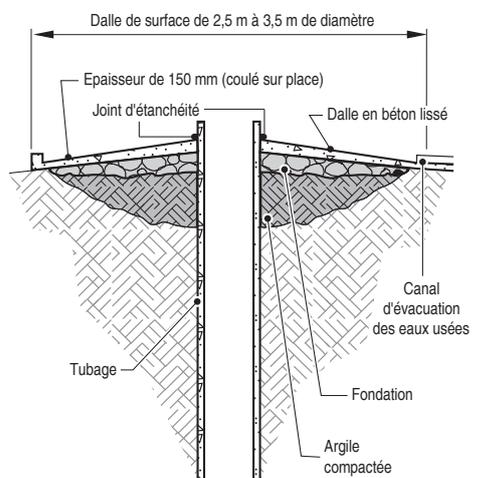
Dalle de surface et joint d'étanchéité (voir Encadré 2.1)
